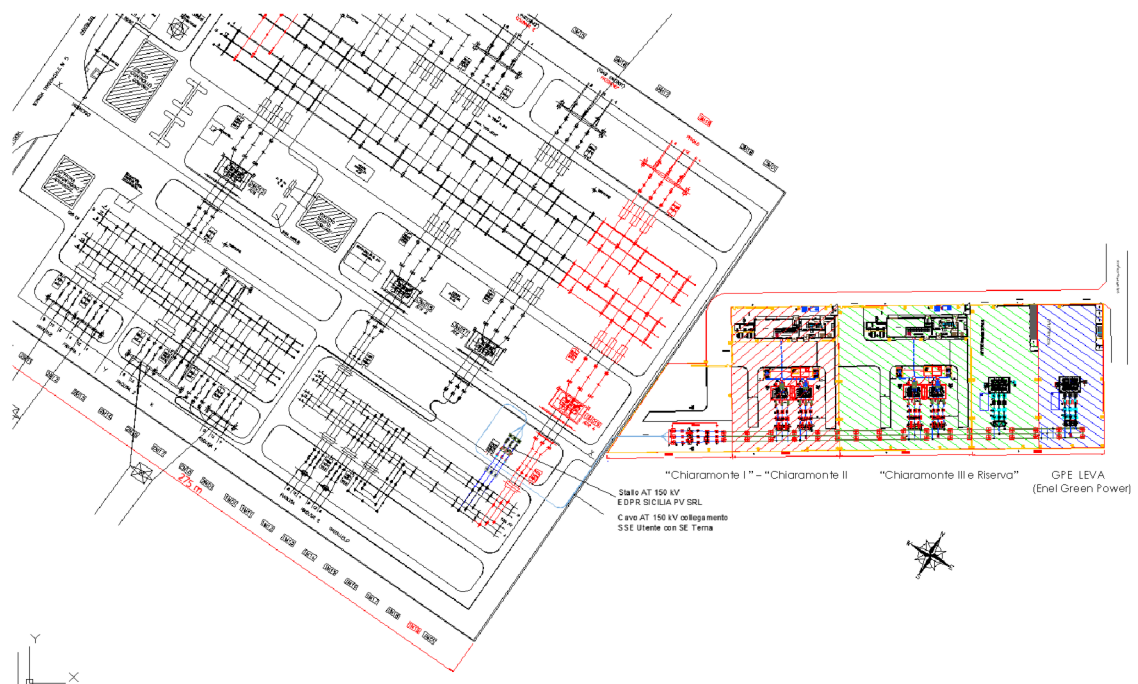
Layout delle opere civili (rif- elab. EPD.UPE)
